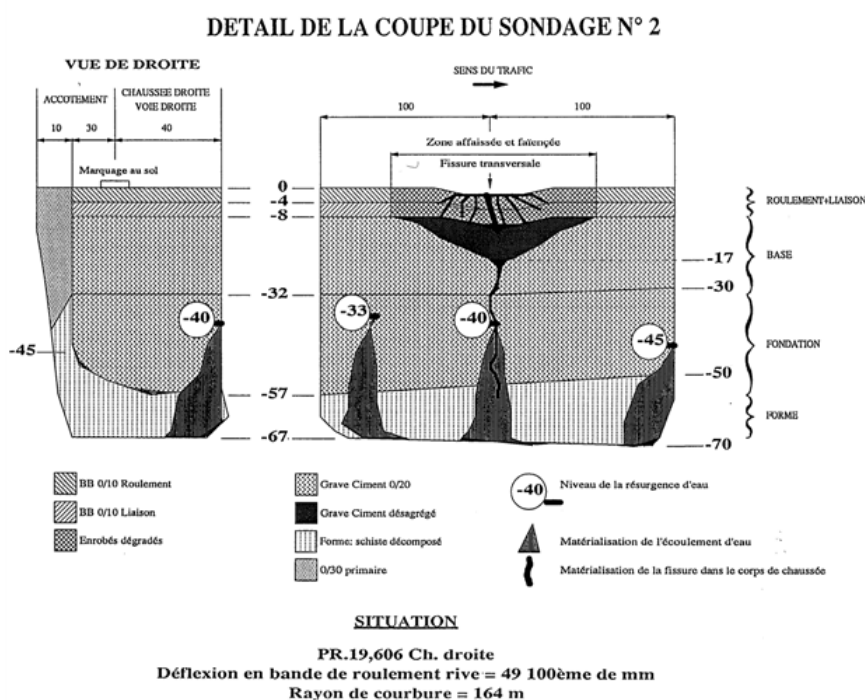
Exemple de sondage au niveau d'une fissure transversale dégradée d'une structure semi-rigide
